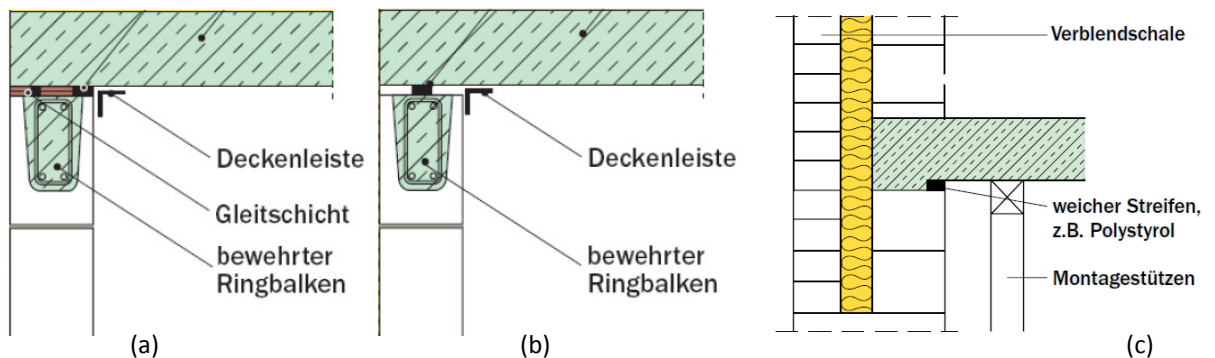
Unterschiedliche Ausführungen zur Zentrierung von Lasten am Wandkopf
